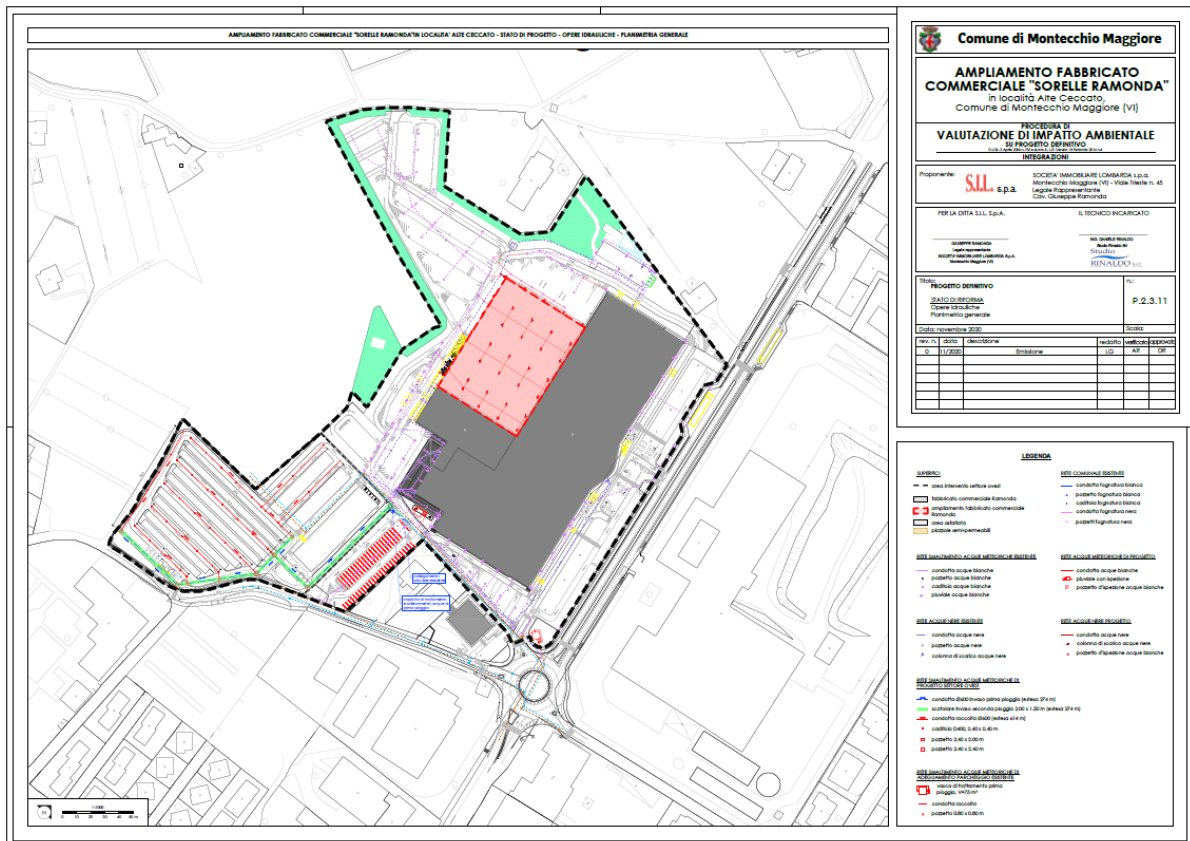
Stato di riforma tavola P.2.3.11 Planimetria opere idrauliche
